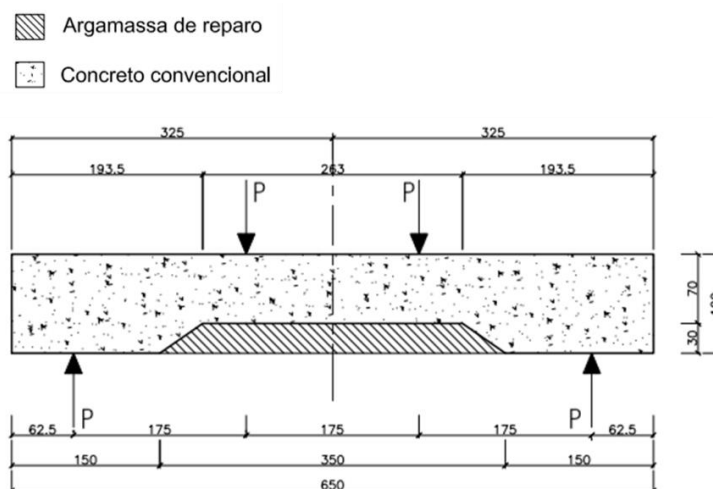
Esquema dos apoios, das cargas concentradas e dimensões das vigas sem armadura para os ensaios de tração na flexão a quatro pontos (dimensões em mm da vista frontal).
